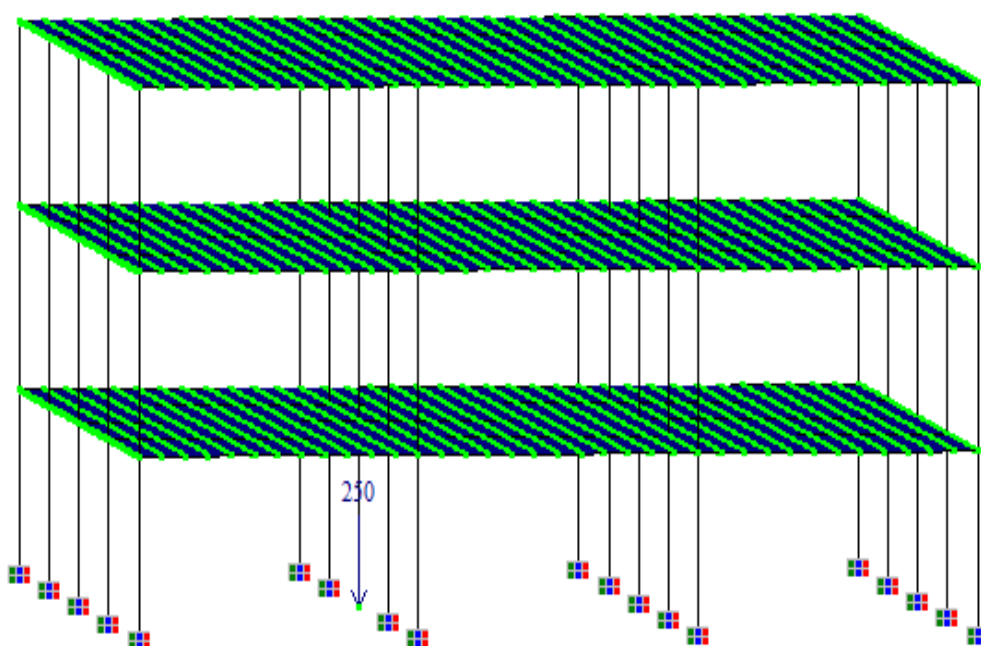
Schéma illustratif du modèle d'étude du bâtiment avec planchers en hourdis à 3 niveaux avec un chargement vertical sur le poteau intermédiaire
